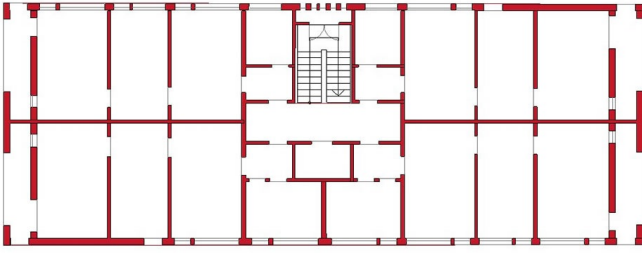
Alcătuirea pereților din panouri mari de beton armat în trei straturi sau din beton monolit în cofraje glisante:
